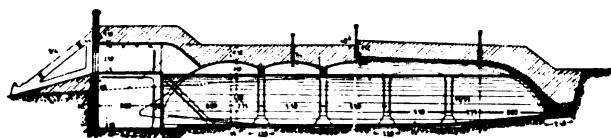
Schnitt durch den Behälter in Agram (I. Zone).
